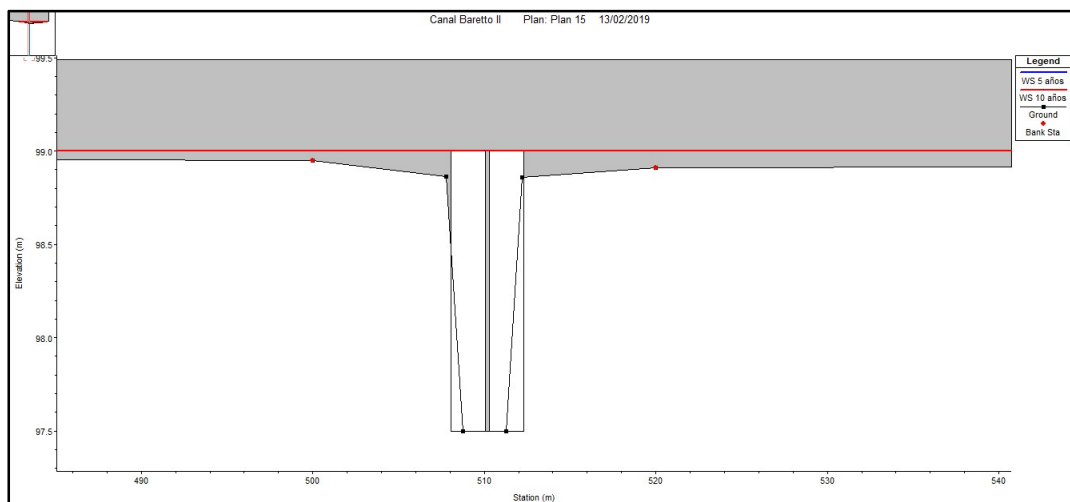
Perfil Transversal Alcantarilla 3 (TR = 5 y 10 años).
